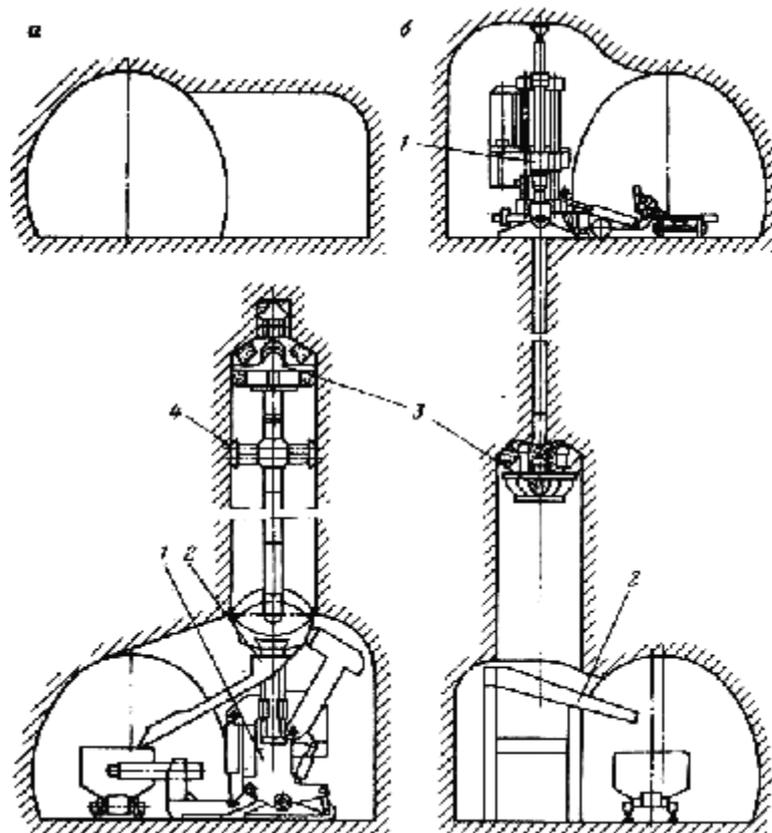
Схемы проходки восстающих бурением: 1 – буровой станок; 2 – шламоулавливающее устройства; 3 – рабочий инструмент; 4 – опорный фонарь
